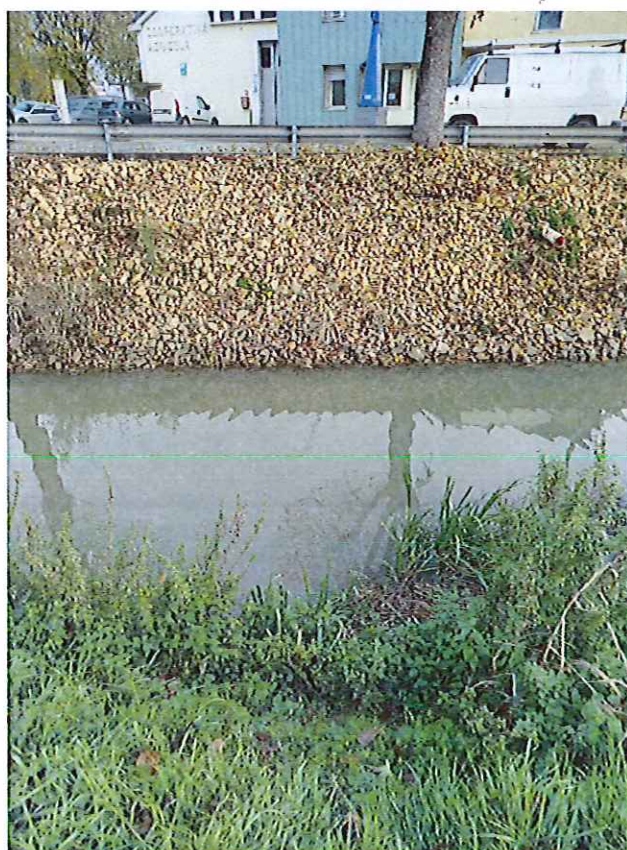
panoramica della sezione n° 2 di rilievo.
